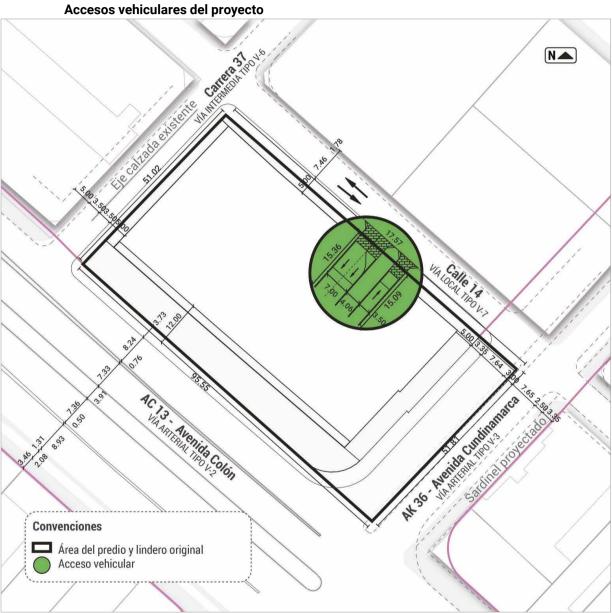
Acceso vehicular al plan parcial Fuente: Elaboración propia
